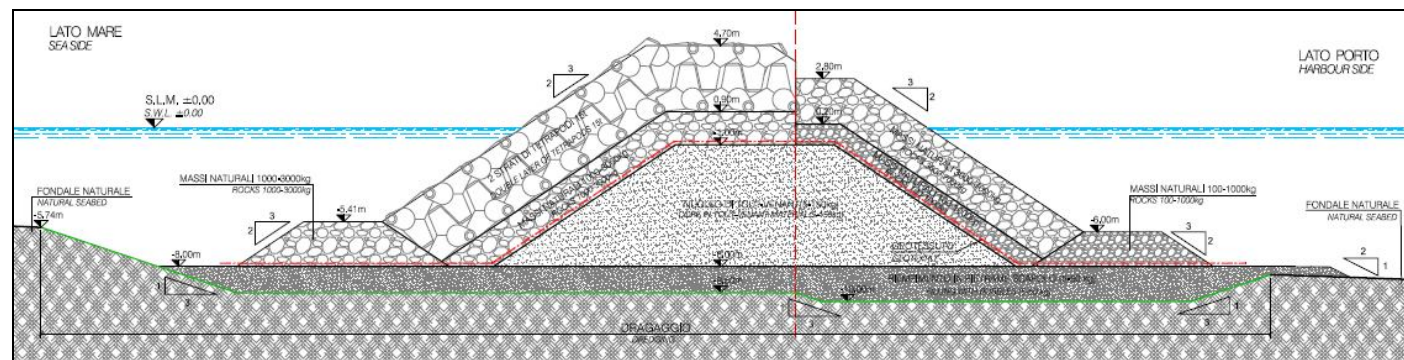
Terza sezione di prova; sezione alla progressiva 250m ma con quota della cresta a 4.70m
